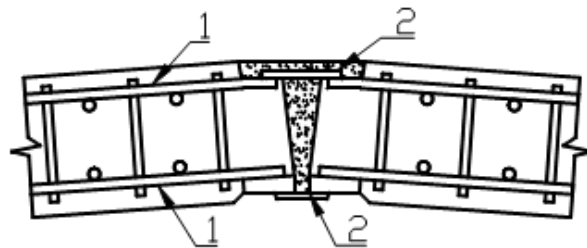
Стик збірних стін на сталевих накладках: 1 – повздожня арматура; 2 – накладки (запозичено з [11]).
